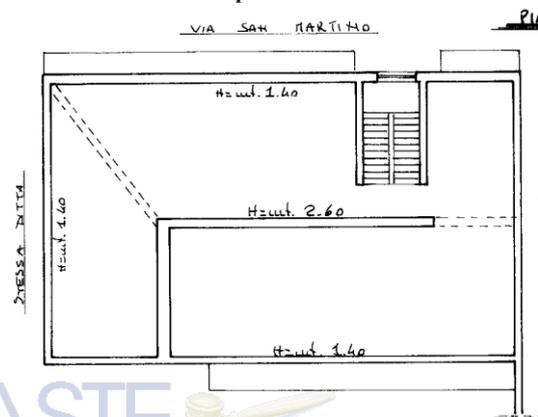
planimetria catastale deposito sottotetto al secondo piano
